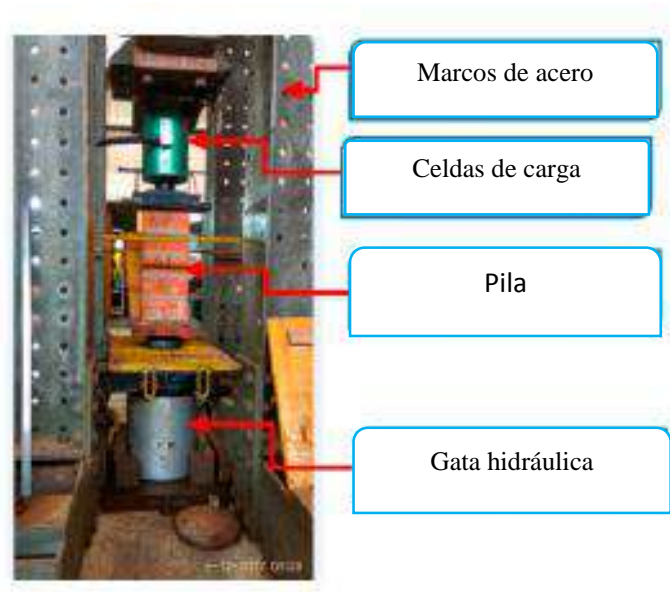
Dispositivos de ensayo para pilas de albañilería.
